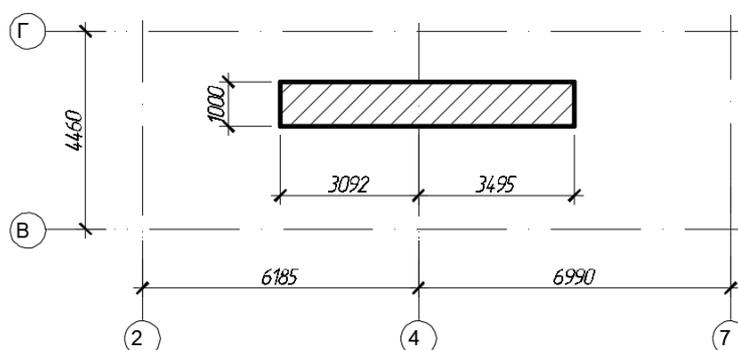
Грузовая площадь на фундамент в осях 4/В-Г
